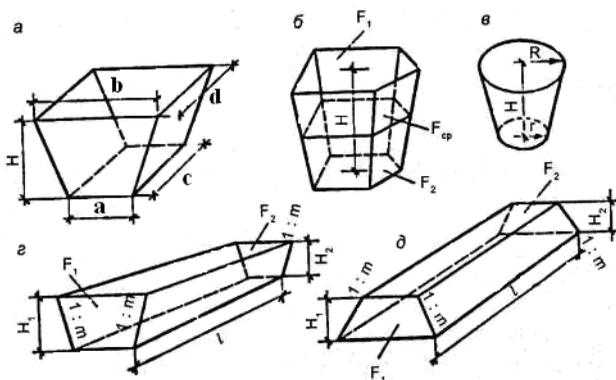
Схема для определения объемов земляных работ при устройстве котлованов, траншей, насыпей: *a, б, в* – котлованы прямоугольные; многоугольные, круглые; *з* – траншея с откосами; *д* – насыпь
